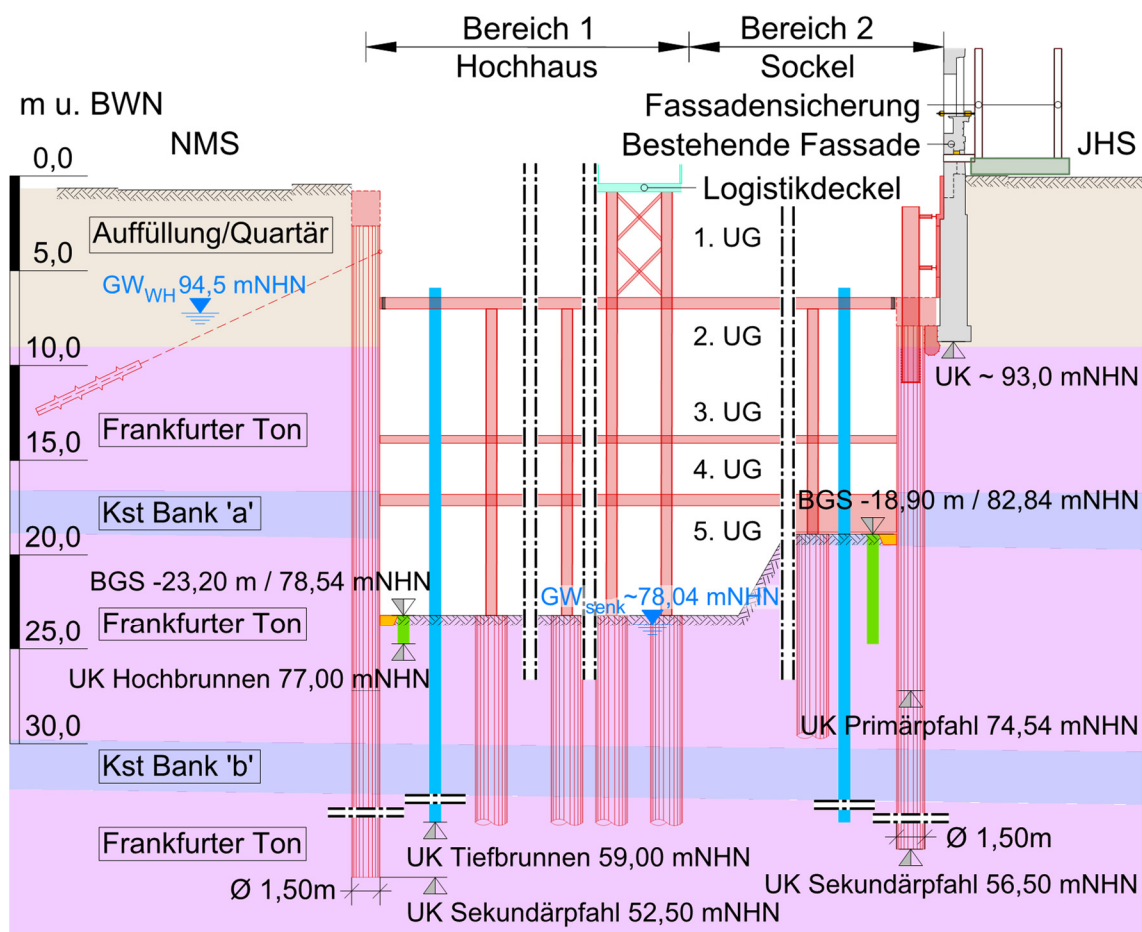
Schnitt A-A, Baugrube in Deckelbauweise nach Endaushub
